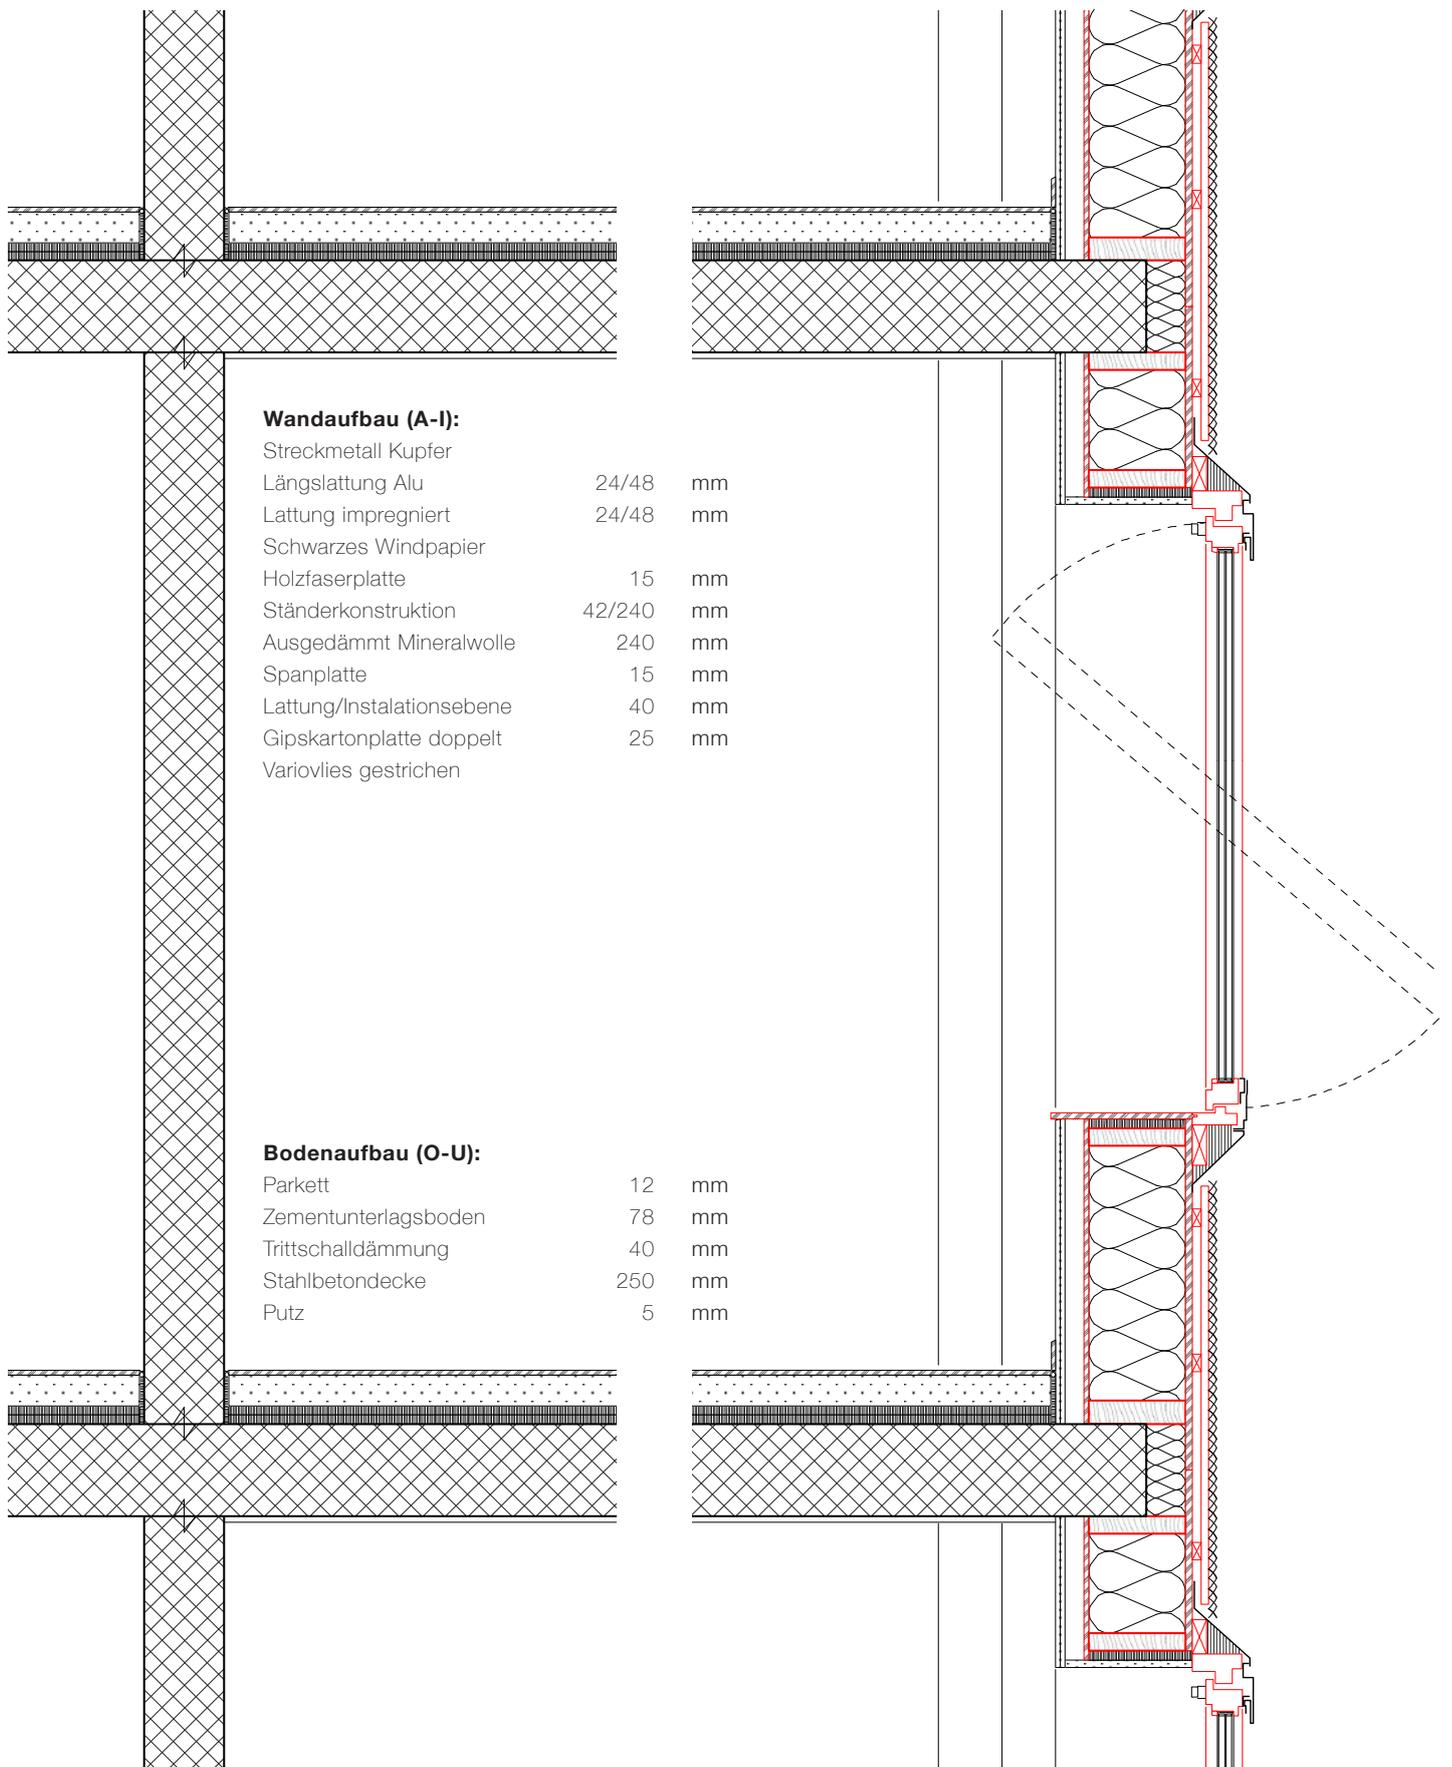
Fassadenschnitt 1:20 Hegenheimerstrasse
